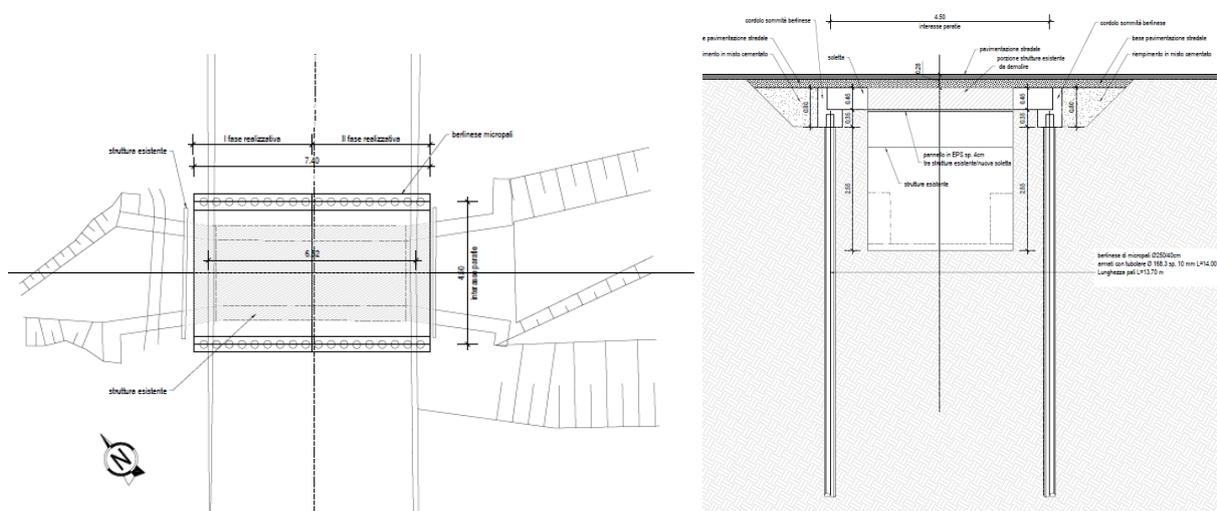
Attraversamento Idraulico km. 52+050 – Planimetria e sezione di progetto
